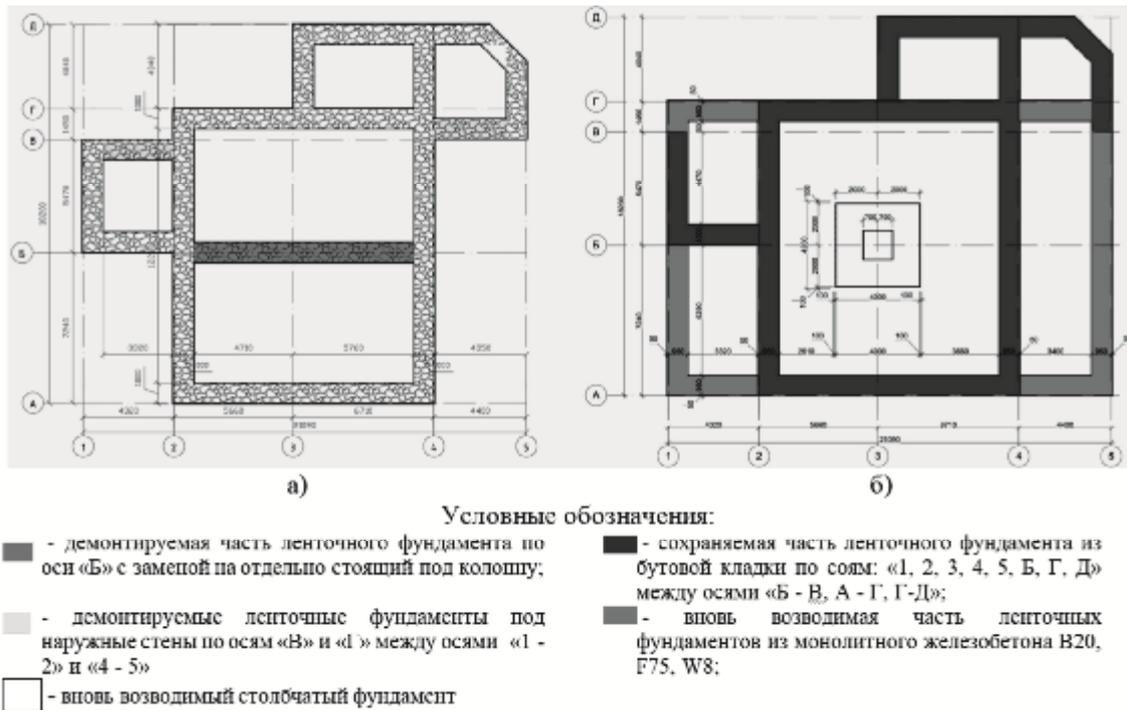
План фундамента: а) до реконструкции со стеновым остовом; б) после реконструкции под остов с неполным каркасом (иллюстрация авторов)
